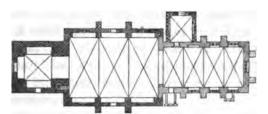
Garz. Peterskirche. Grundriss. 1:667. Triumpfbogen gedrückt spitzbogig.
